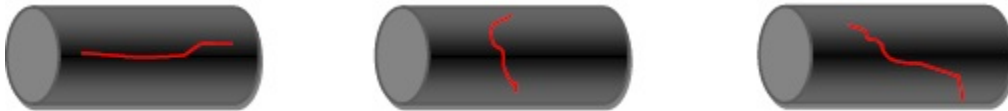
Fisuras en tuberías: longitudinales, transversales y combinadas
